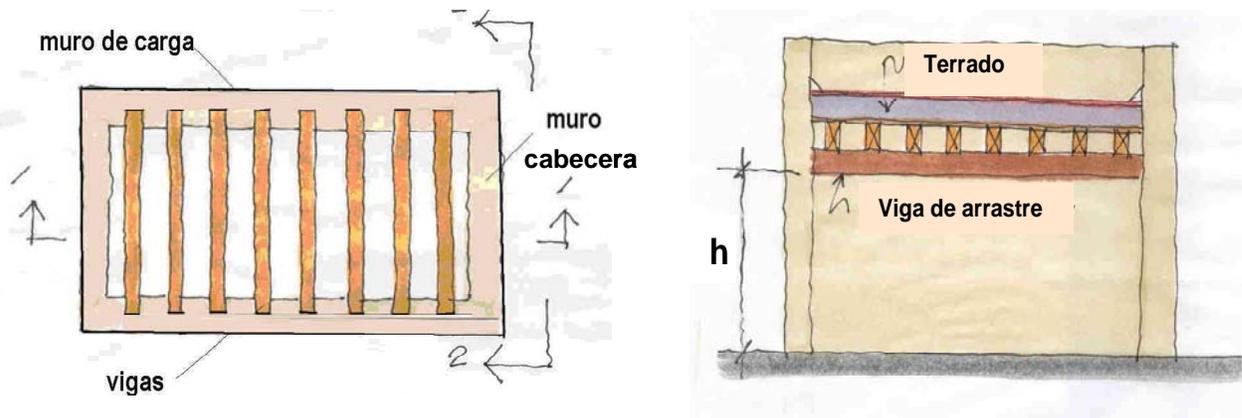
Planta y corte colocación de vigas de madera, sobre muros de adobe.
